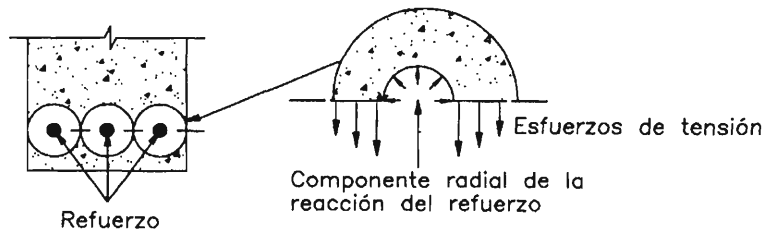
Tensión en el concreto generada por las varillas de acero
